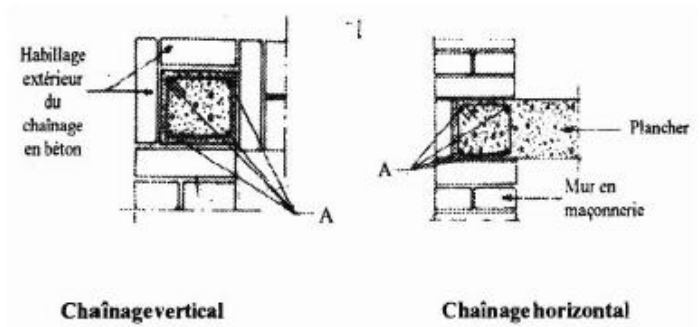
Armatures minimales des chaînages horizontaux et verticaux
